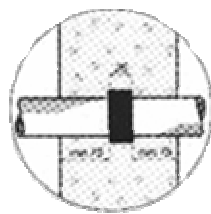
Принципиальная схема устройства бентонитовой гидроизоляции при возведении фундаментов
